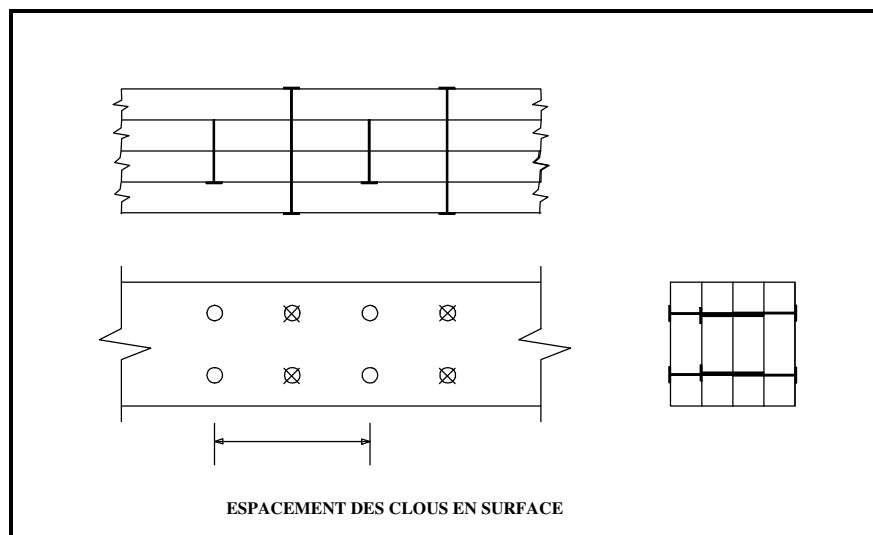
Disposition des clous pour ferme maîtresse à 3 plis
